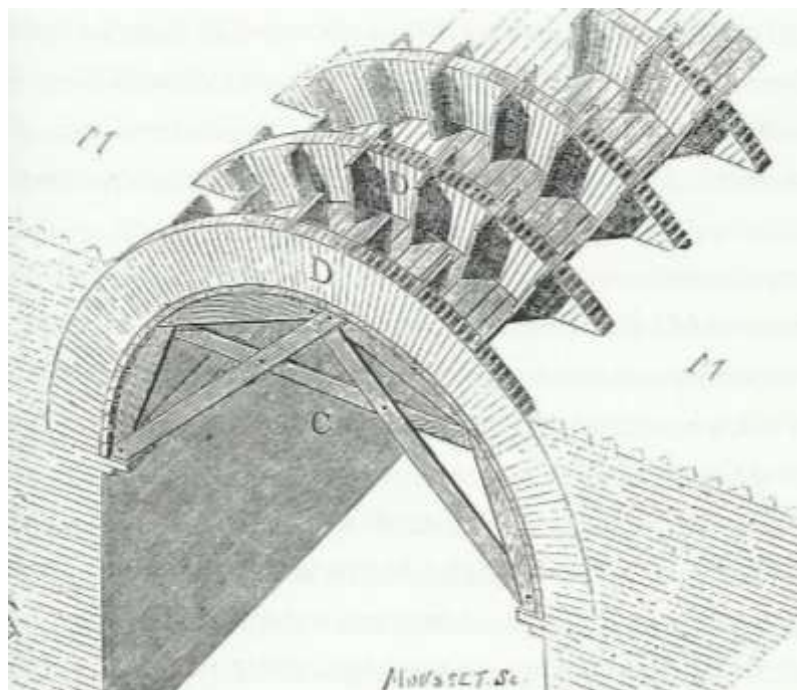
Detalle de encofrado de una bóveda de cañón con nervios interiores de ladrillo a modo de encofrado permanente. (Imagen 13 en Choisy 1999:33)).
